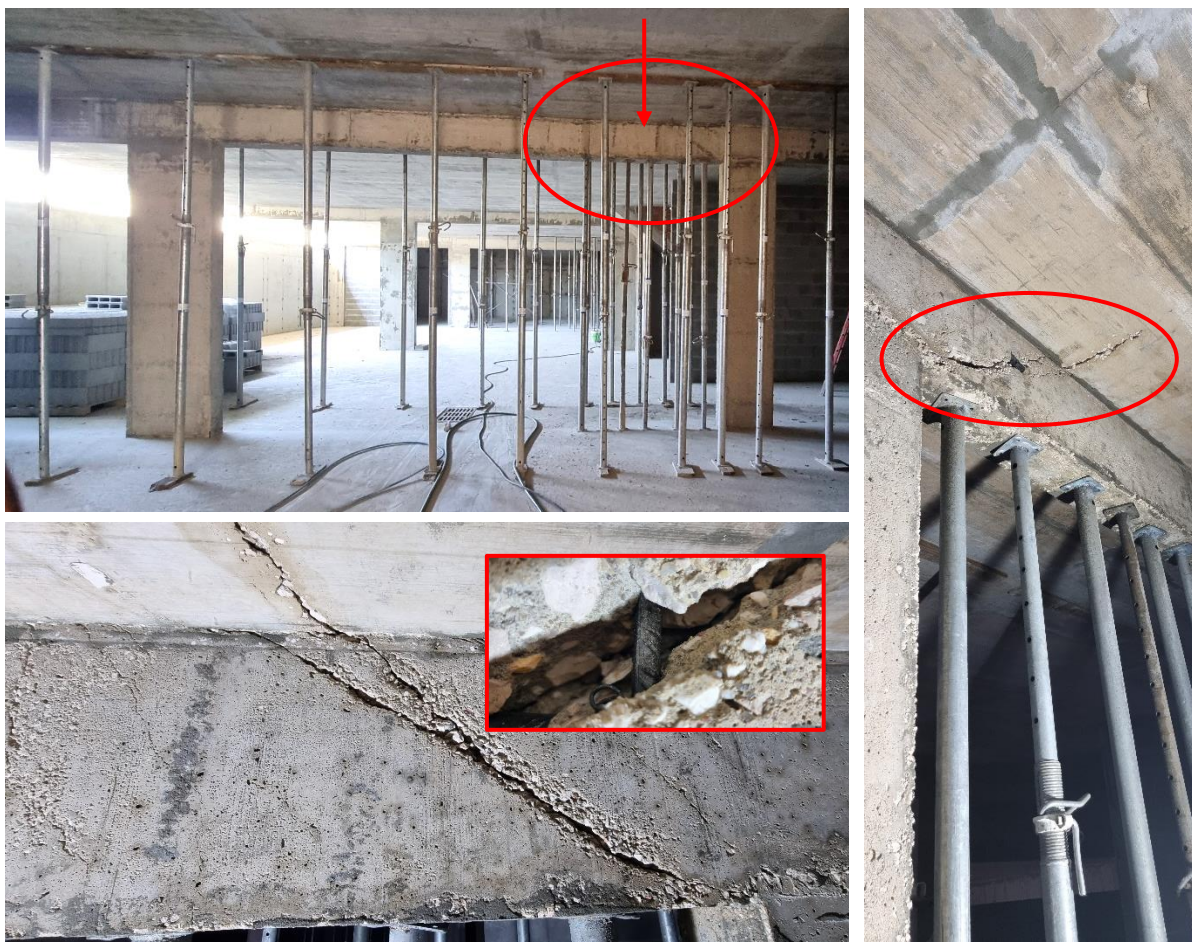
Vista geral de uma das vigas fissuradas e detalhes da fissura.
